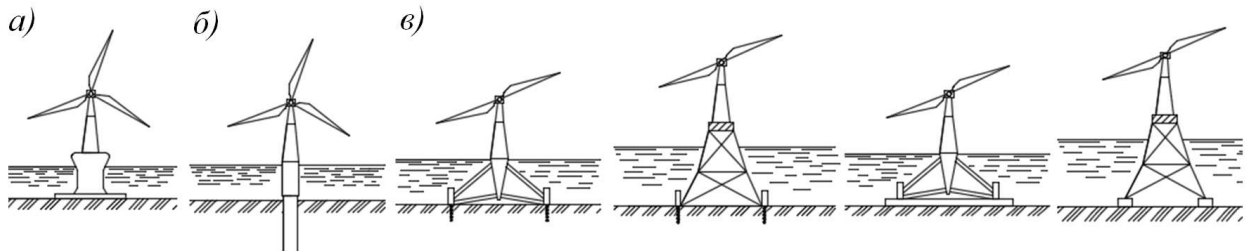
Некоторые типы фундаментов под ВЭУ: а) бетонный короб; б) односвайное основание; в) основания в виде треног и ферменных конструкций
